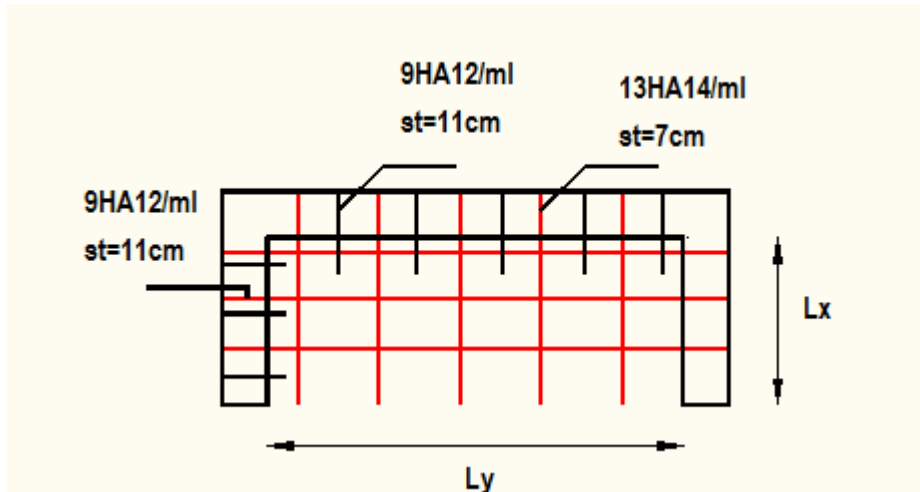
Schémas de ferrailage de la terrasse inaccessible.
